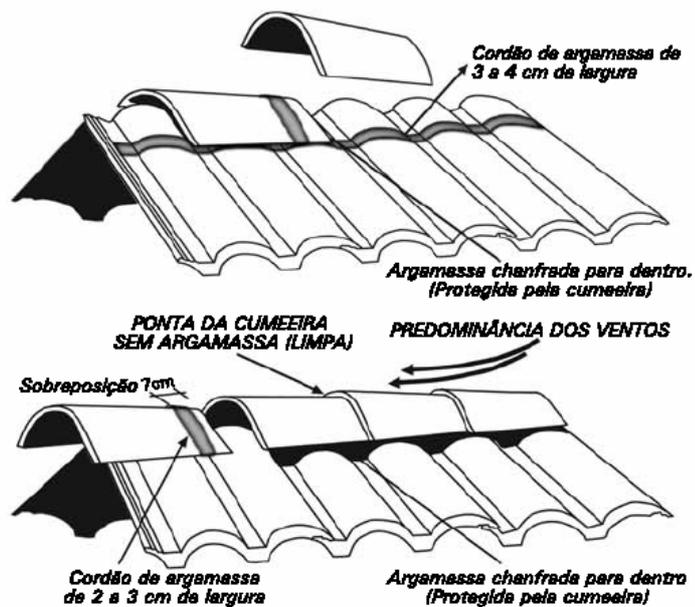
Detalhe cumeeira - telhas de concreto tipo clássica. Fonte: Tégula.
